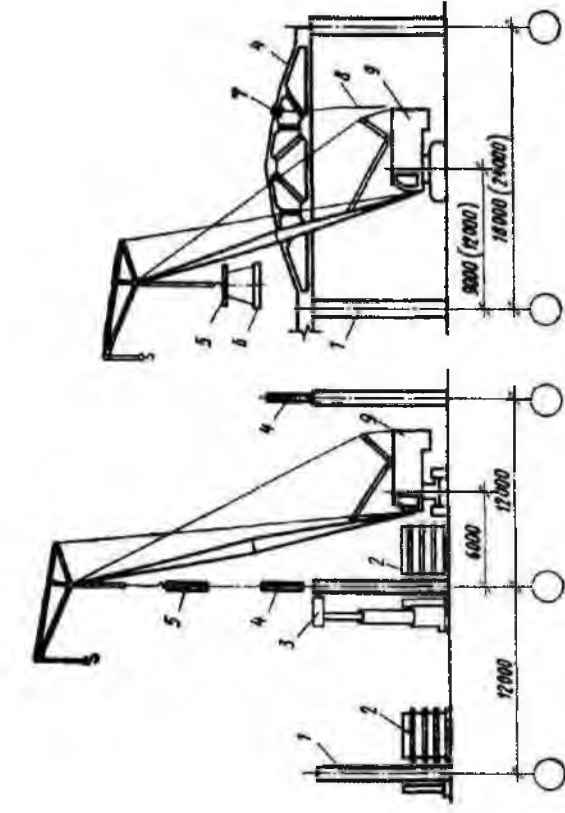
Схема монтажа стеновых ограждающих панелей, кассета расположена между краном и стеной:
